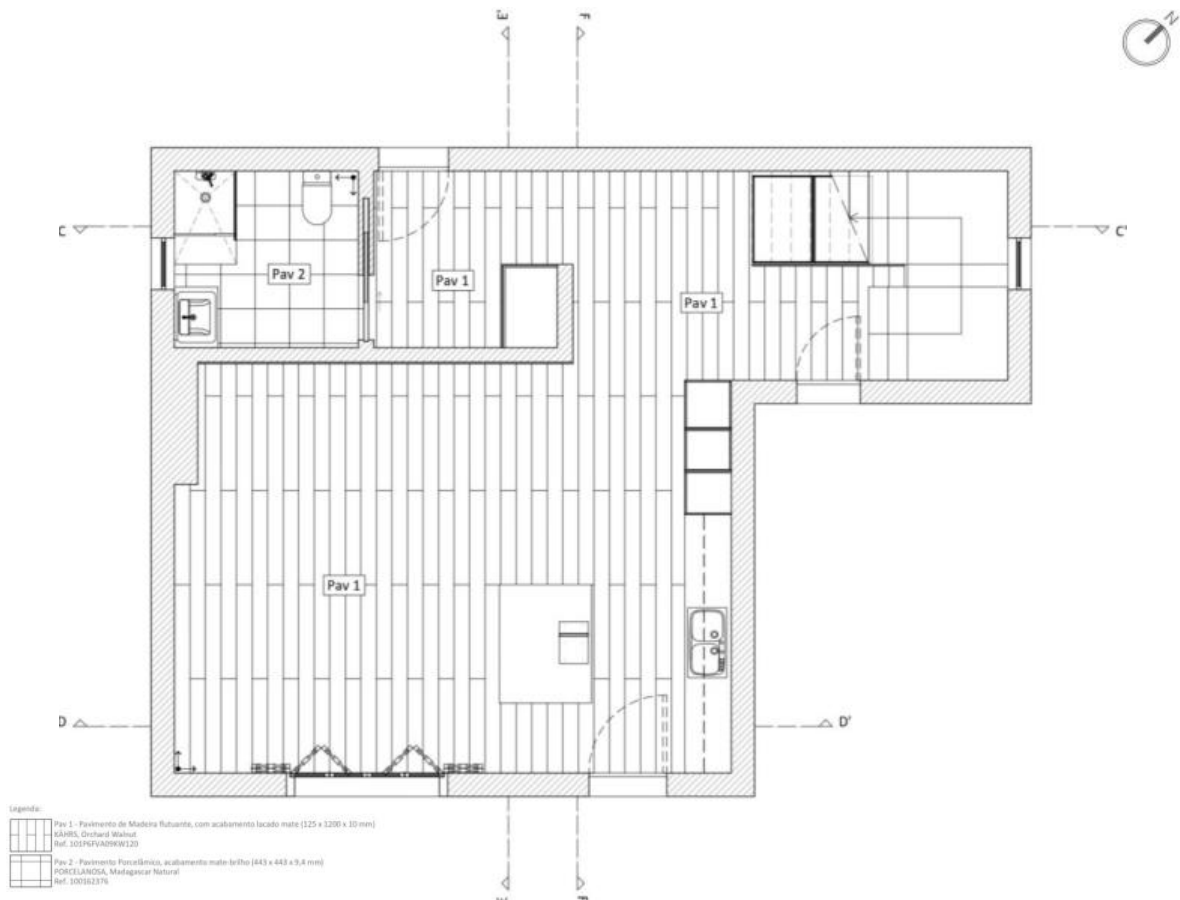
Planta de Pavimento, Piso 0. Fonte: Autor
